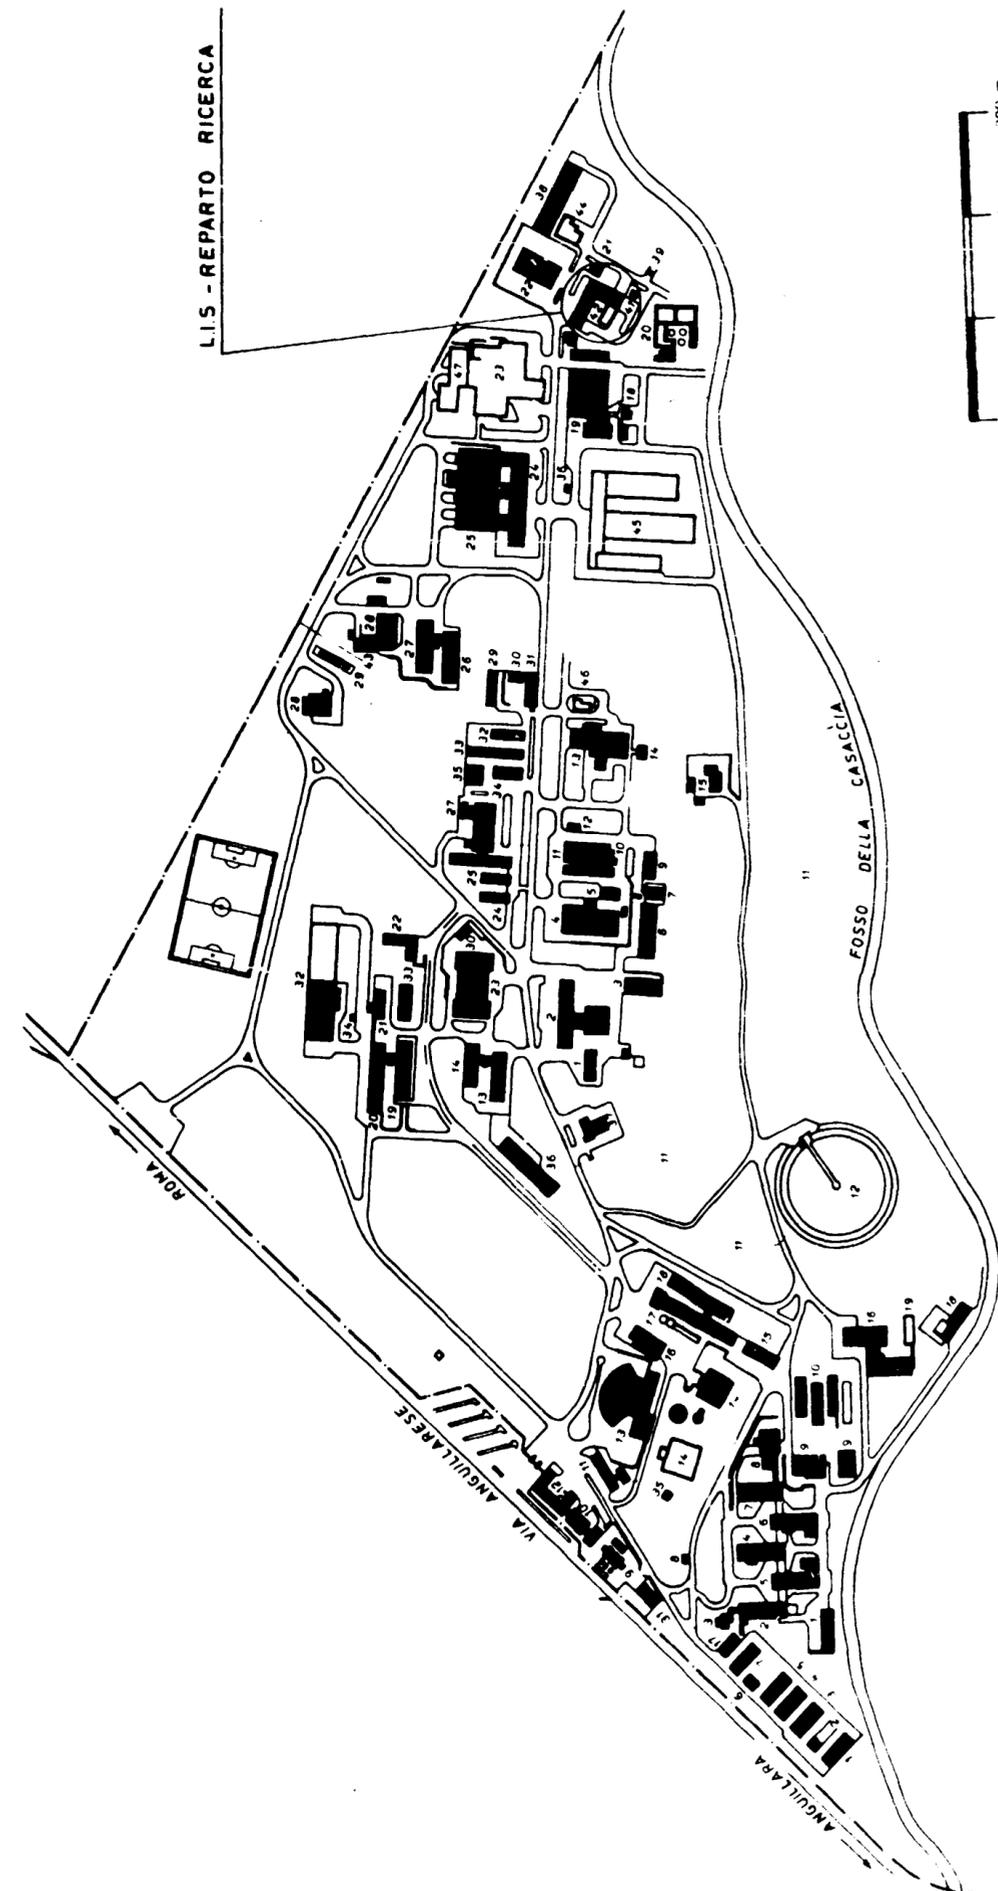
CS.N. CASACCIA - Planimetria generale.
